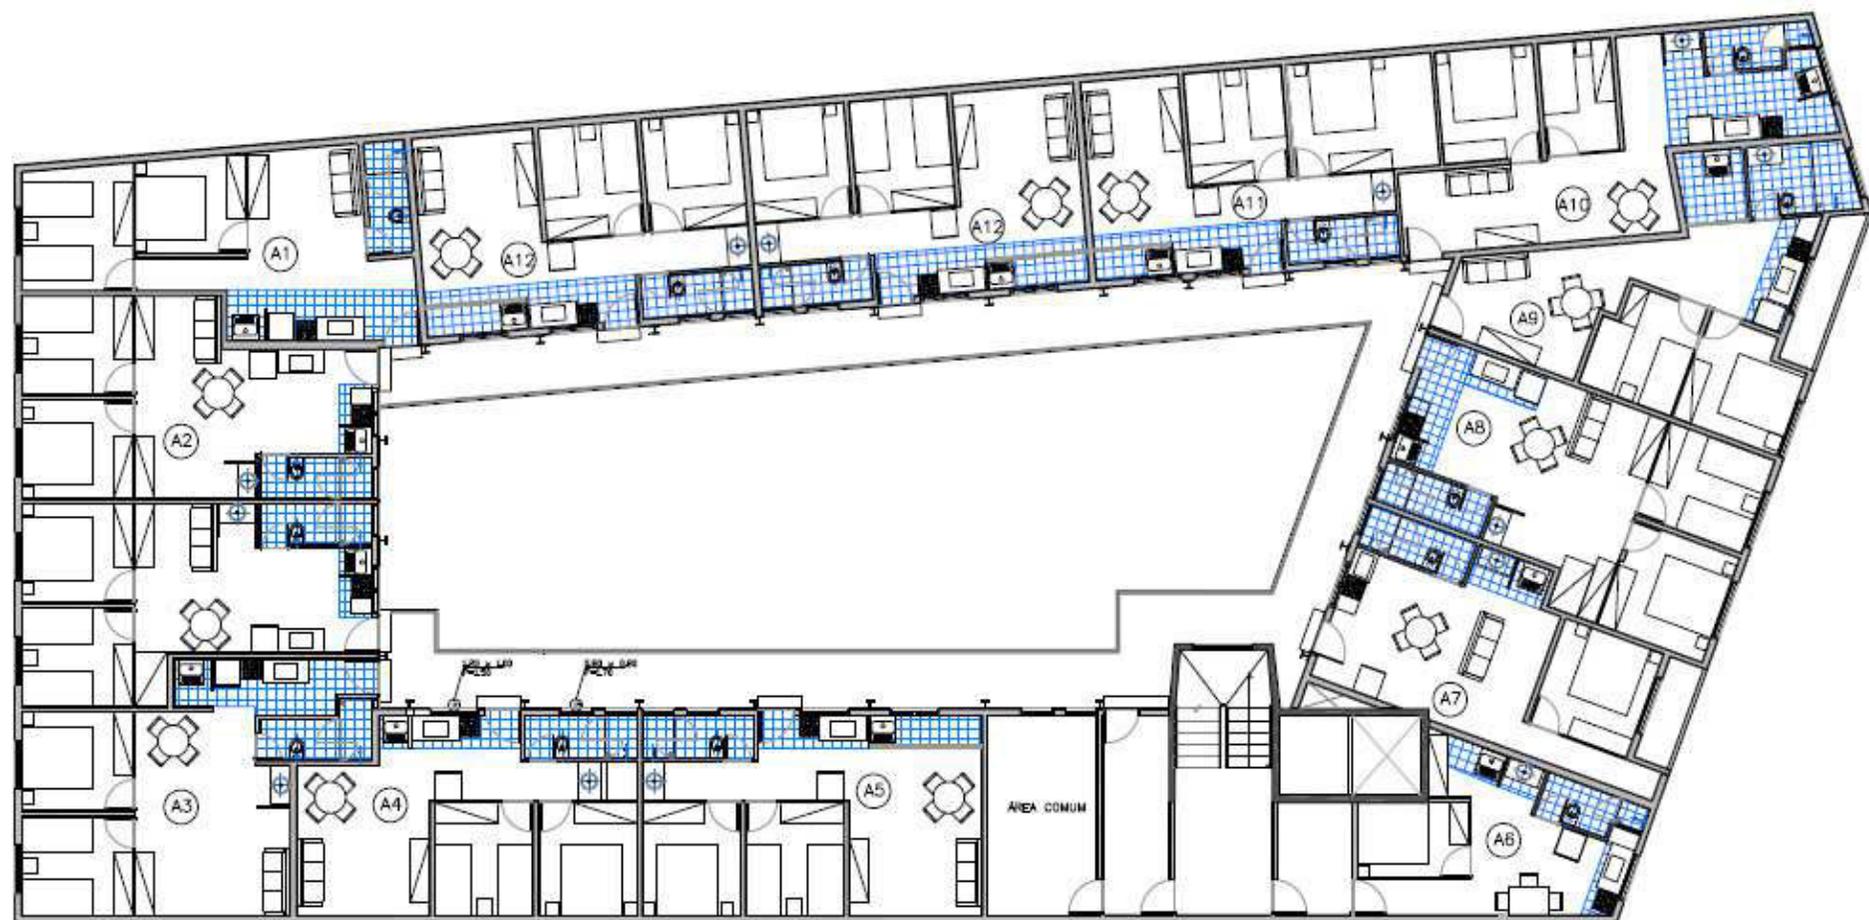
pavimento, com a passarela passando pelo pátio interno.
